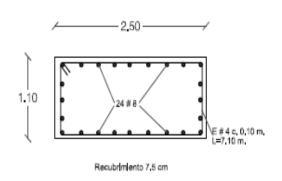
DETALLE ESTRIBO DIAGONAL VASTAGO PILA CENTRAL
